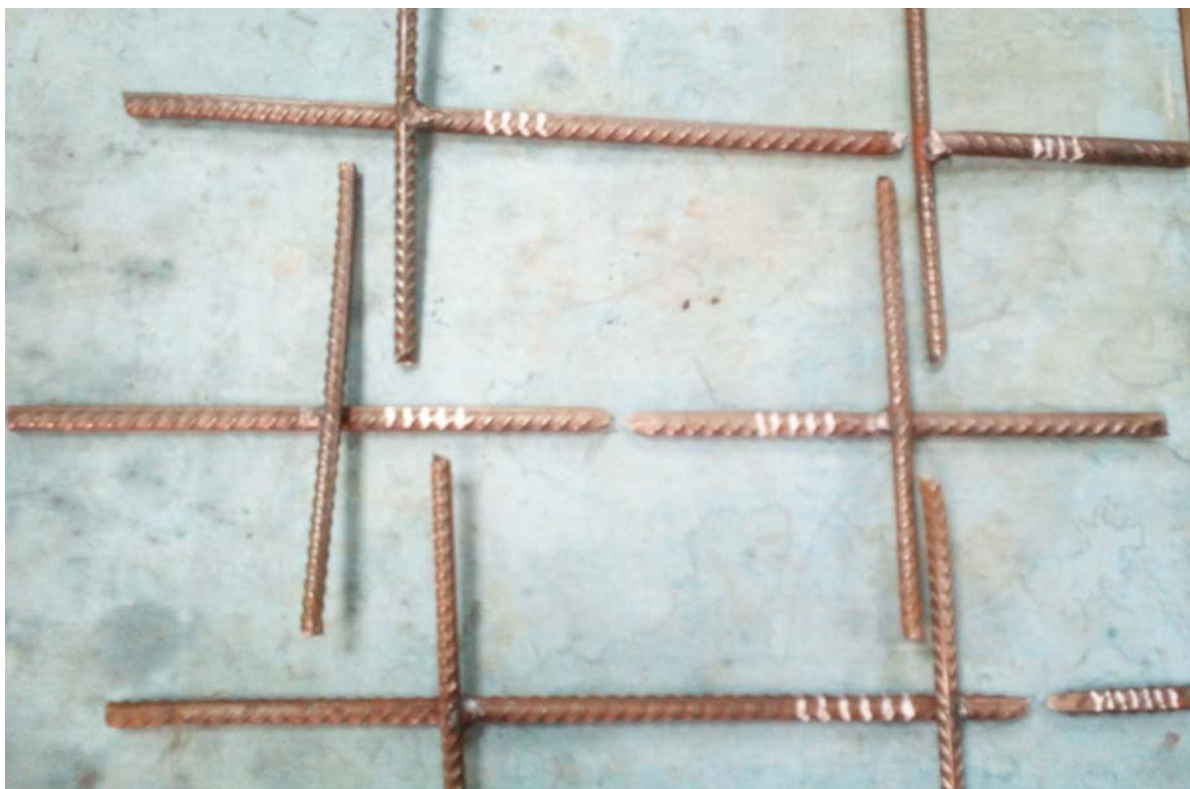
Образцы арматурного проката со сварными швами после испытаний на прочность
